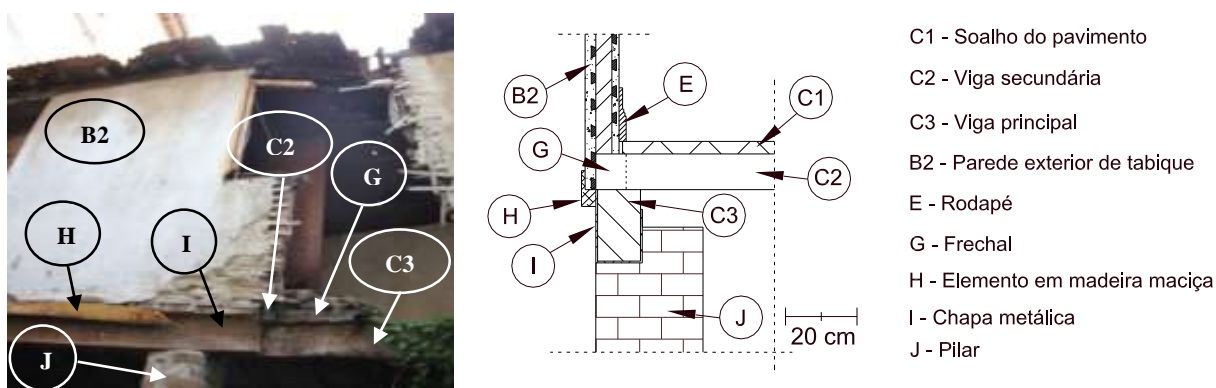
Ligação entre a parede exterior de tabique e o pavimento do 1º andar, detalhe VI
